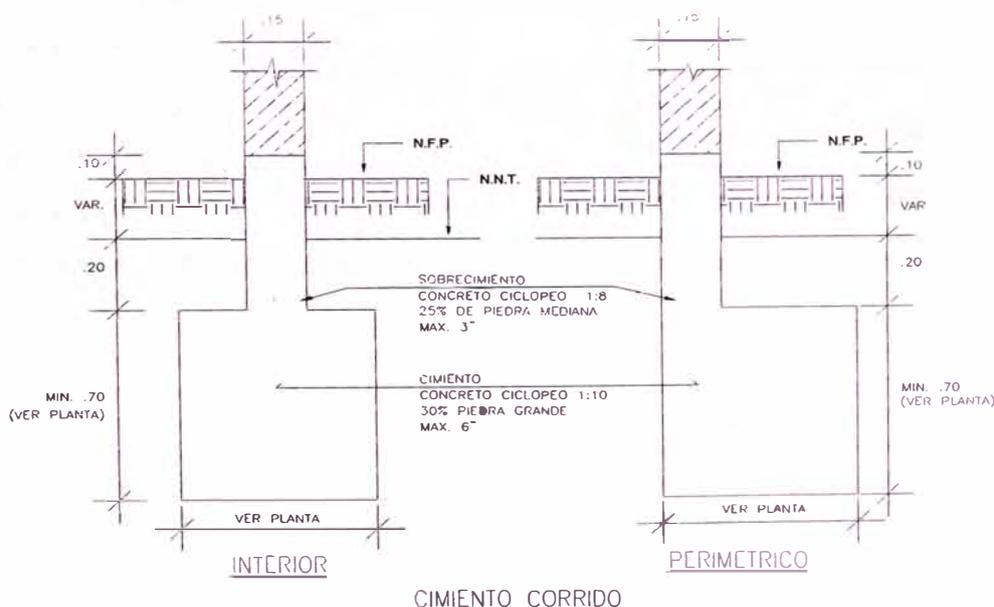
Detalle Representativo de Cimentación Corrida Típica
